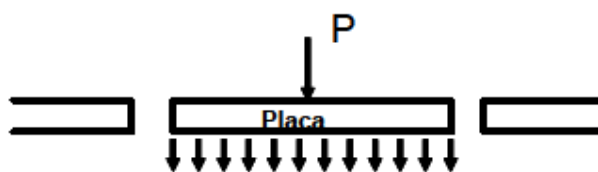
Distribuição do carregamento - Pavimento Rígido.
